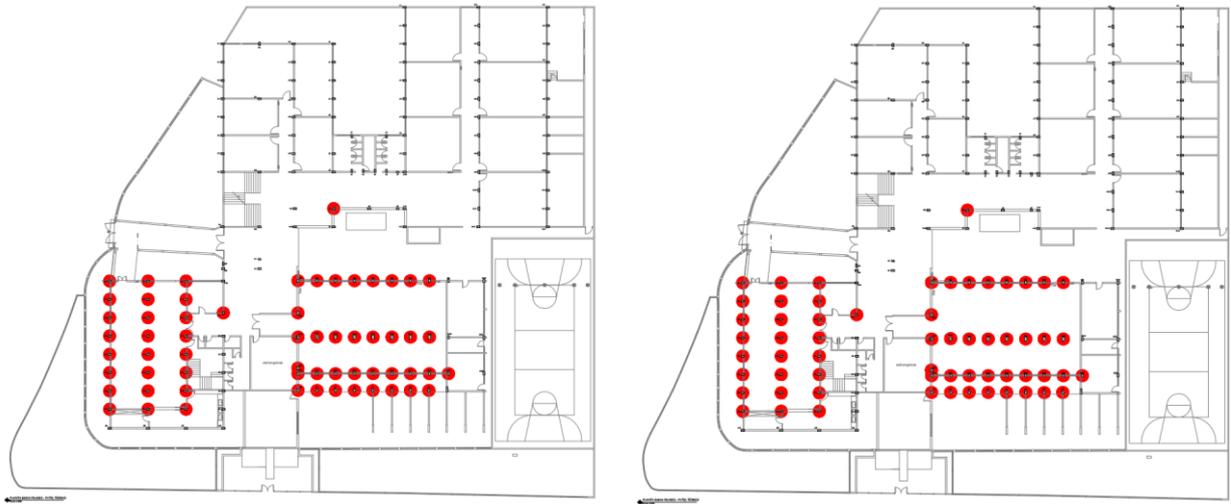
Pilares com armaduras expostas no pavimento térreo e superior (direita)
